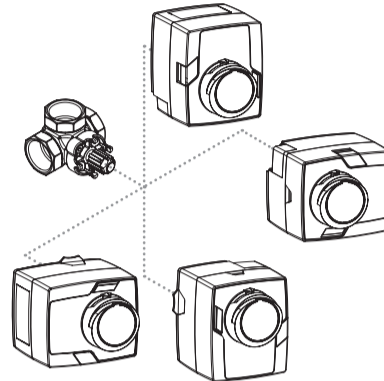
Монтажные позиции и установка указательного кольца и шкалы
